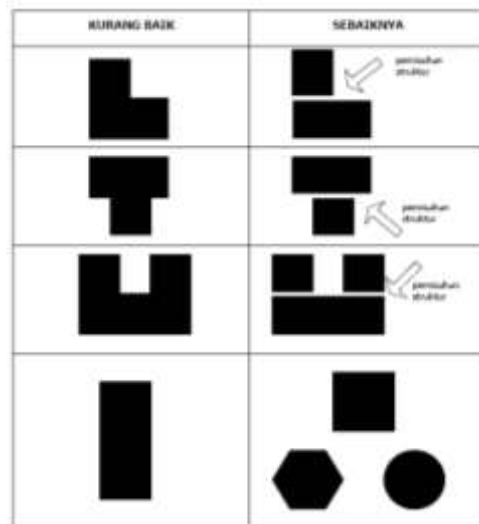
Denah Bangunan yang tidak Simetris.
